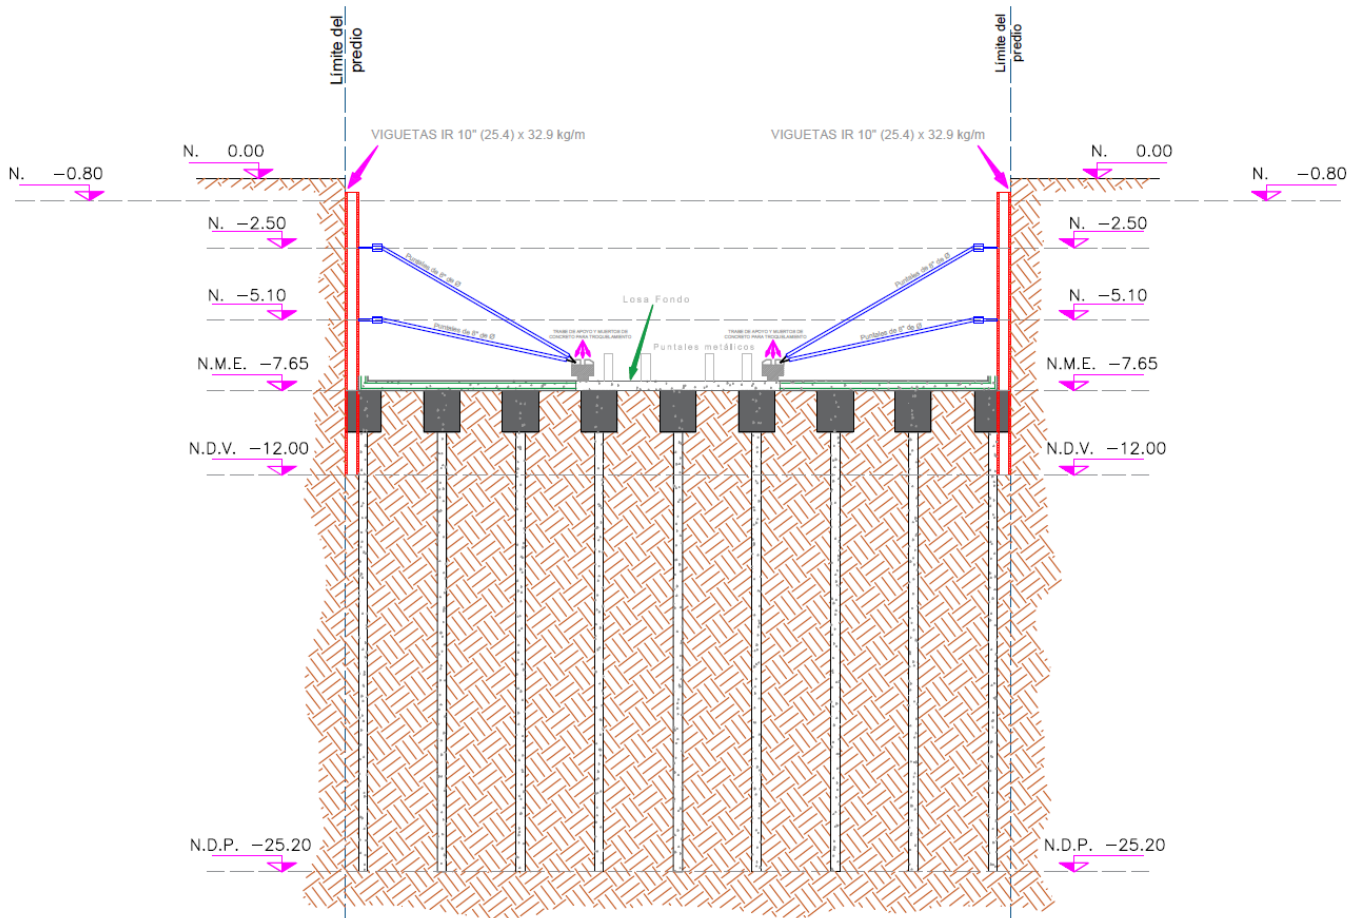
COLADO DE DADOS Y LOSA FONDO EN LA PARTE RESTANTE DE LA PRIMERA ETAPA DE EXCAVACIÓN
